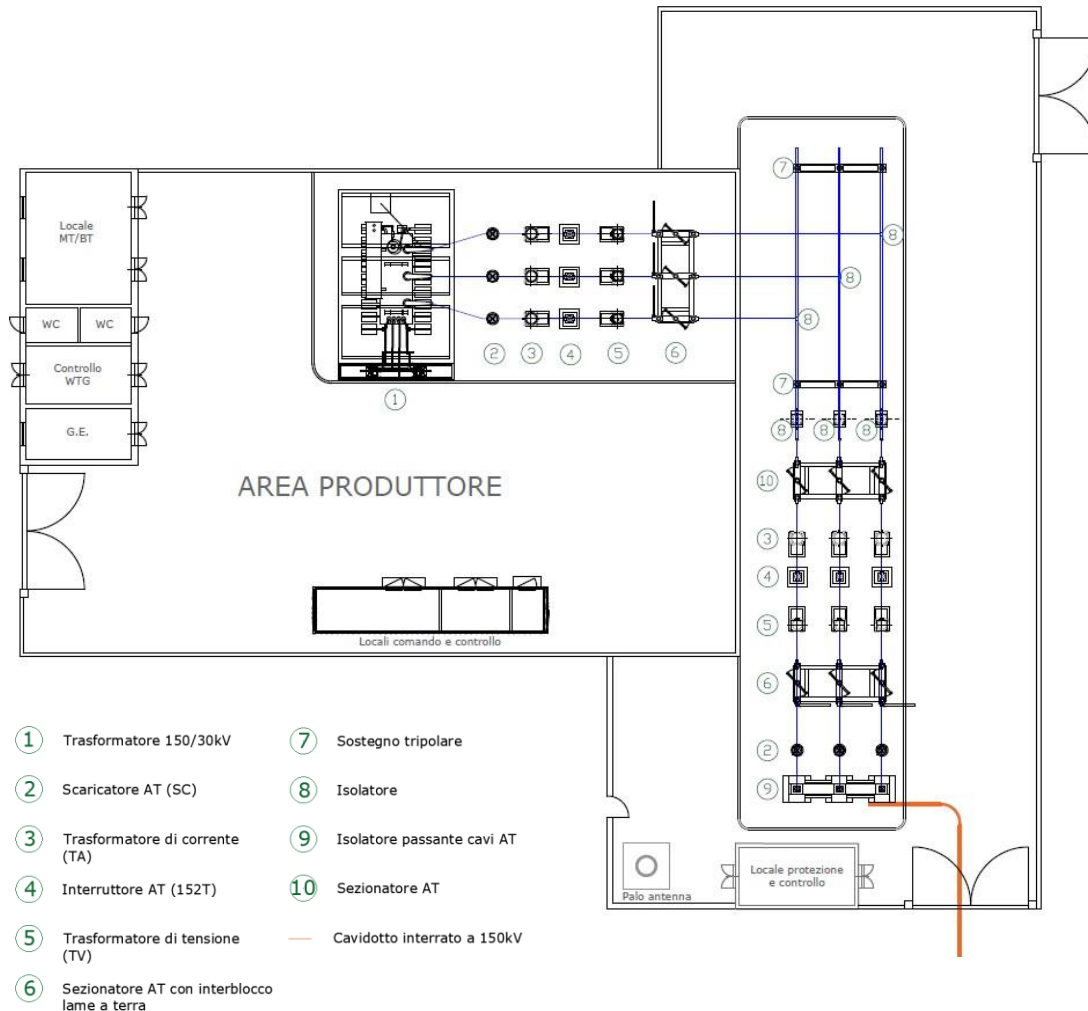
Planimetria della SSE utente di trasformazione 150/30 kV
